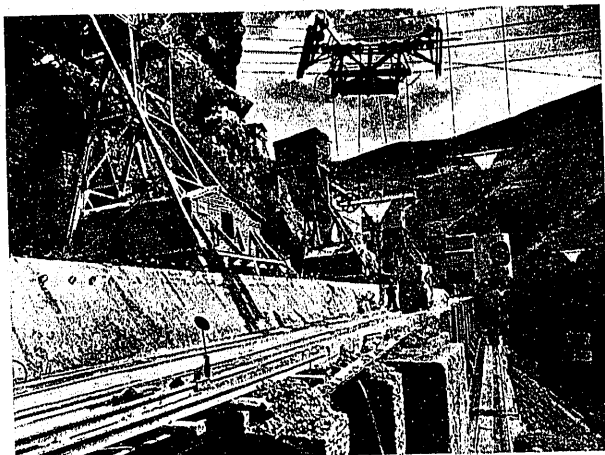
Salto de Salime. Plataforma de cables-grúa. Al fondo, instalaciones de hormigonado y llegada de cintas de dosificadoras automáticas.
